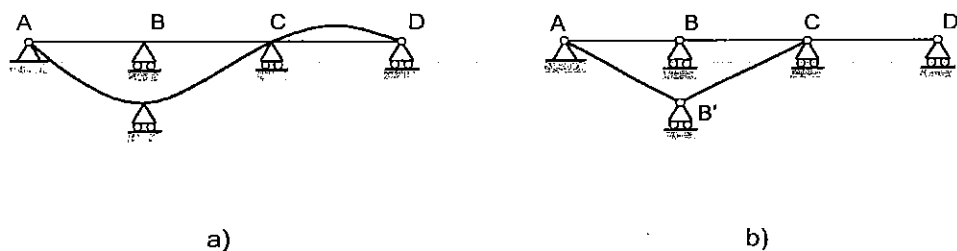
Efecto de un asentamiento: a) en la viga continua, b) en el sistema de vigas biapoyadas
